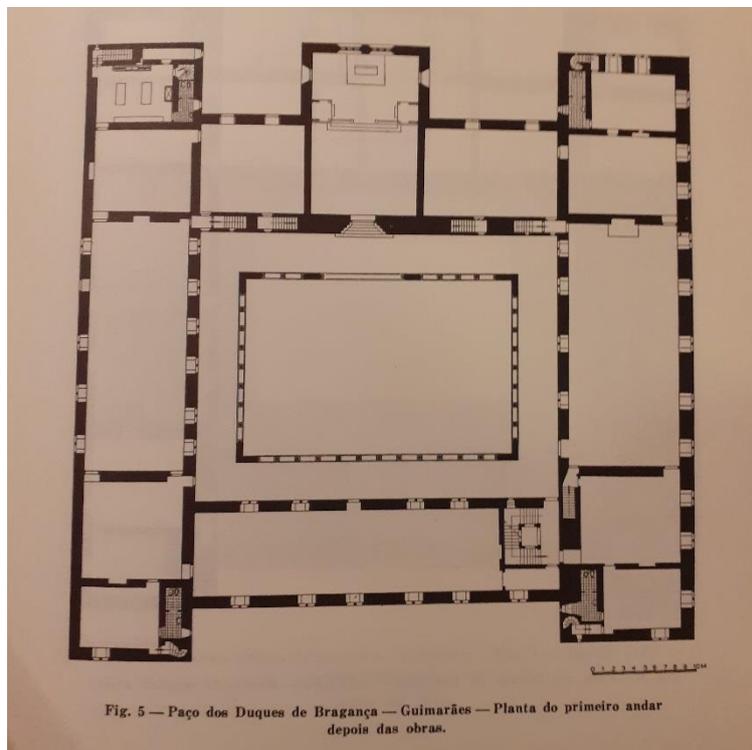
Planta do primeiro andar do Paço dos Duques de Bragança após o restauro.
